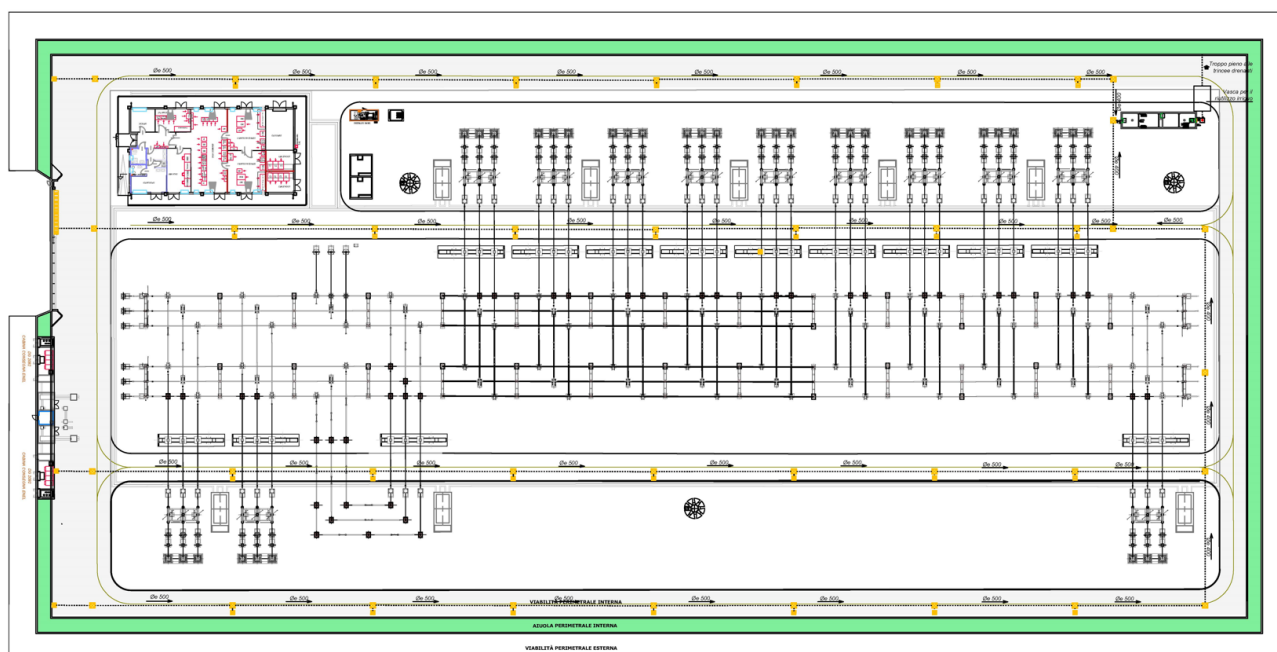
2 Planimetria ampliamento stazione elettrica con relativo impianto di trattamento delle acque meteoriche
